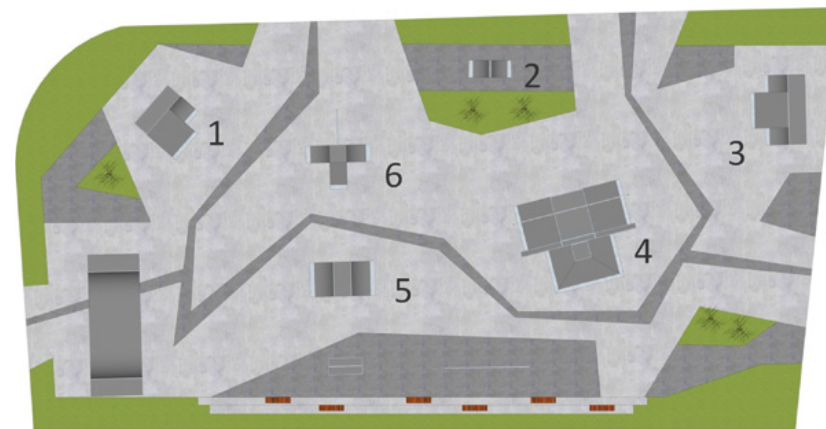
Przykład prawidłowo zaprojektowanego skateparku z zachowaniem stref bezpieczeństwa oraz prawidłowo opracowanymi liniami przejazdu w Brzesczyczach
